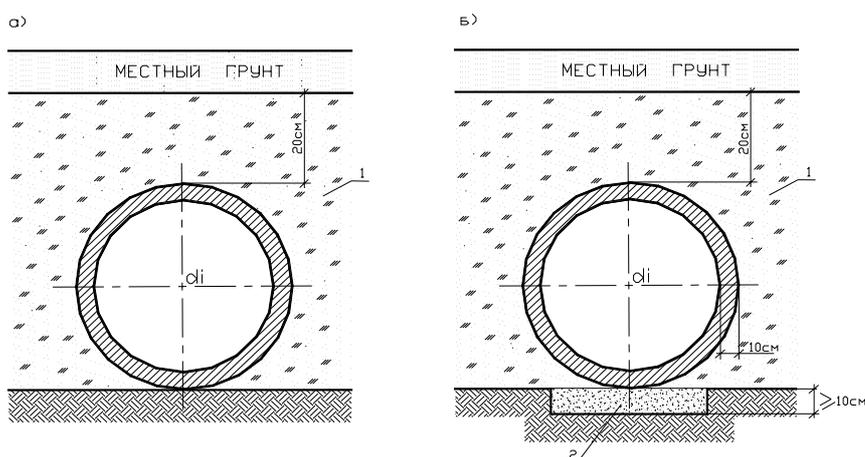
Тип 1 основания труб ТВ: 1- грунт повышенной степени уплотнения; 2- подушка песчаная.
